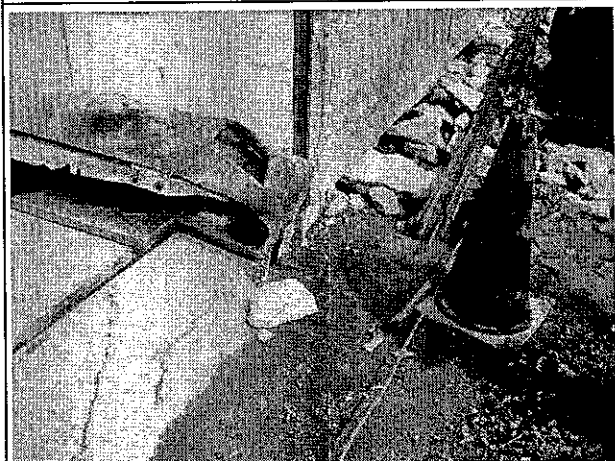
Pavimentação da pista de rodagem que avança do segmento de acesso sul para o interior do túnel
